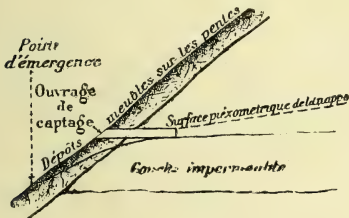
Captage d'une source d'affleurement. (Imbeaux.)
